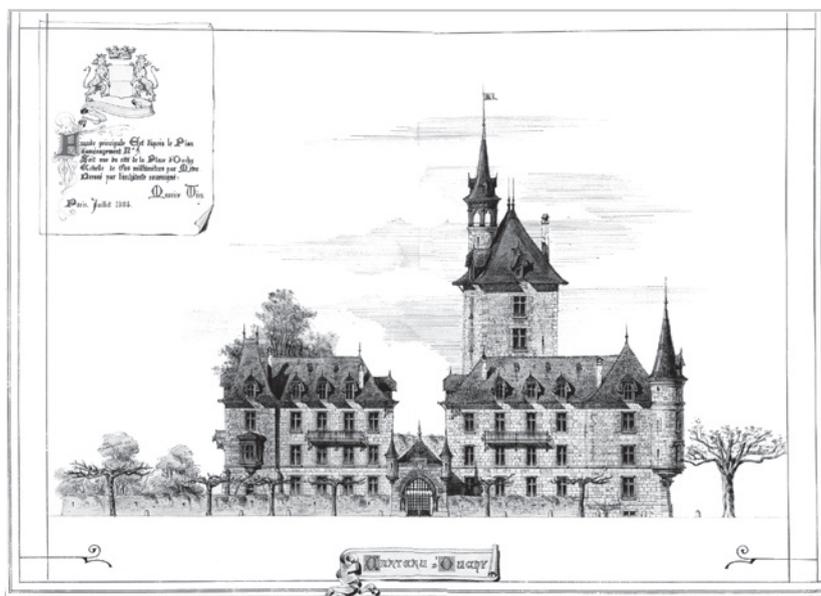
Château d'Ouchy. Façade principale Est d'après le Plan d'aménagement N° 3. Soit vue du côté de la Place d'Ouchy, par Maurice Wirz, juillet 1884 (AM).
